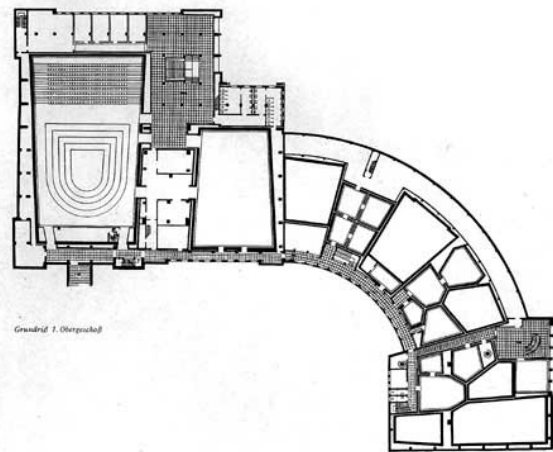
Funkhaus des Radios in Berlin-Rummelsburg, Grundriss des ersten Obergeschosses (*Deutsche Architektur* 9/1956)
